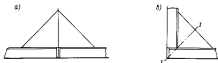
Конструктивные схемы узла с линиями: а - элемент перерезанной балки; б - локализованное угловое сжатие.
